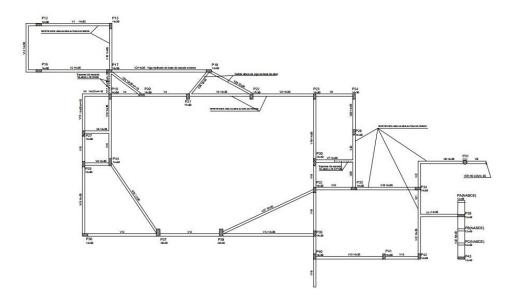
Fôrmas do Pavimento Garagem Fonte: Projeto Estrutural (2017)
